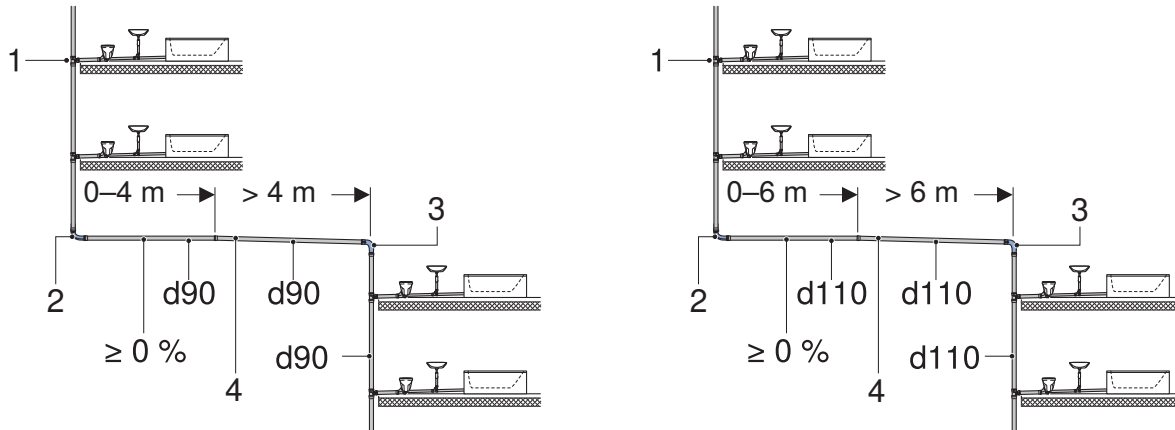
Ausführung Falleitungsverziehung über 4 m (d90) bzw. 6 m (d110) in einer Falleitung mit Geberit Silent-Pro SuperTube, mit Anschlüssen an die Falleitung nach der Falleitungsverziehung
